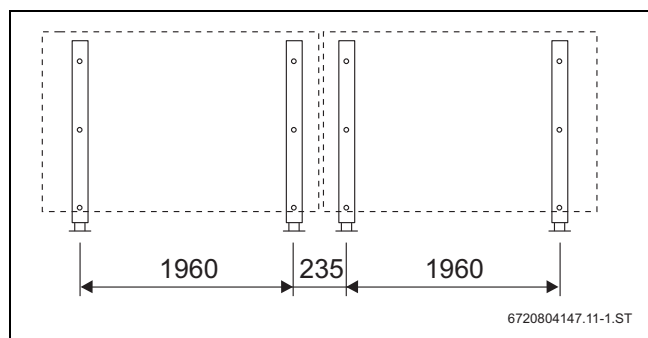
Grundauführung, 2 waagerechte Kollektoren (Maße in mm)
